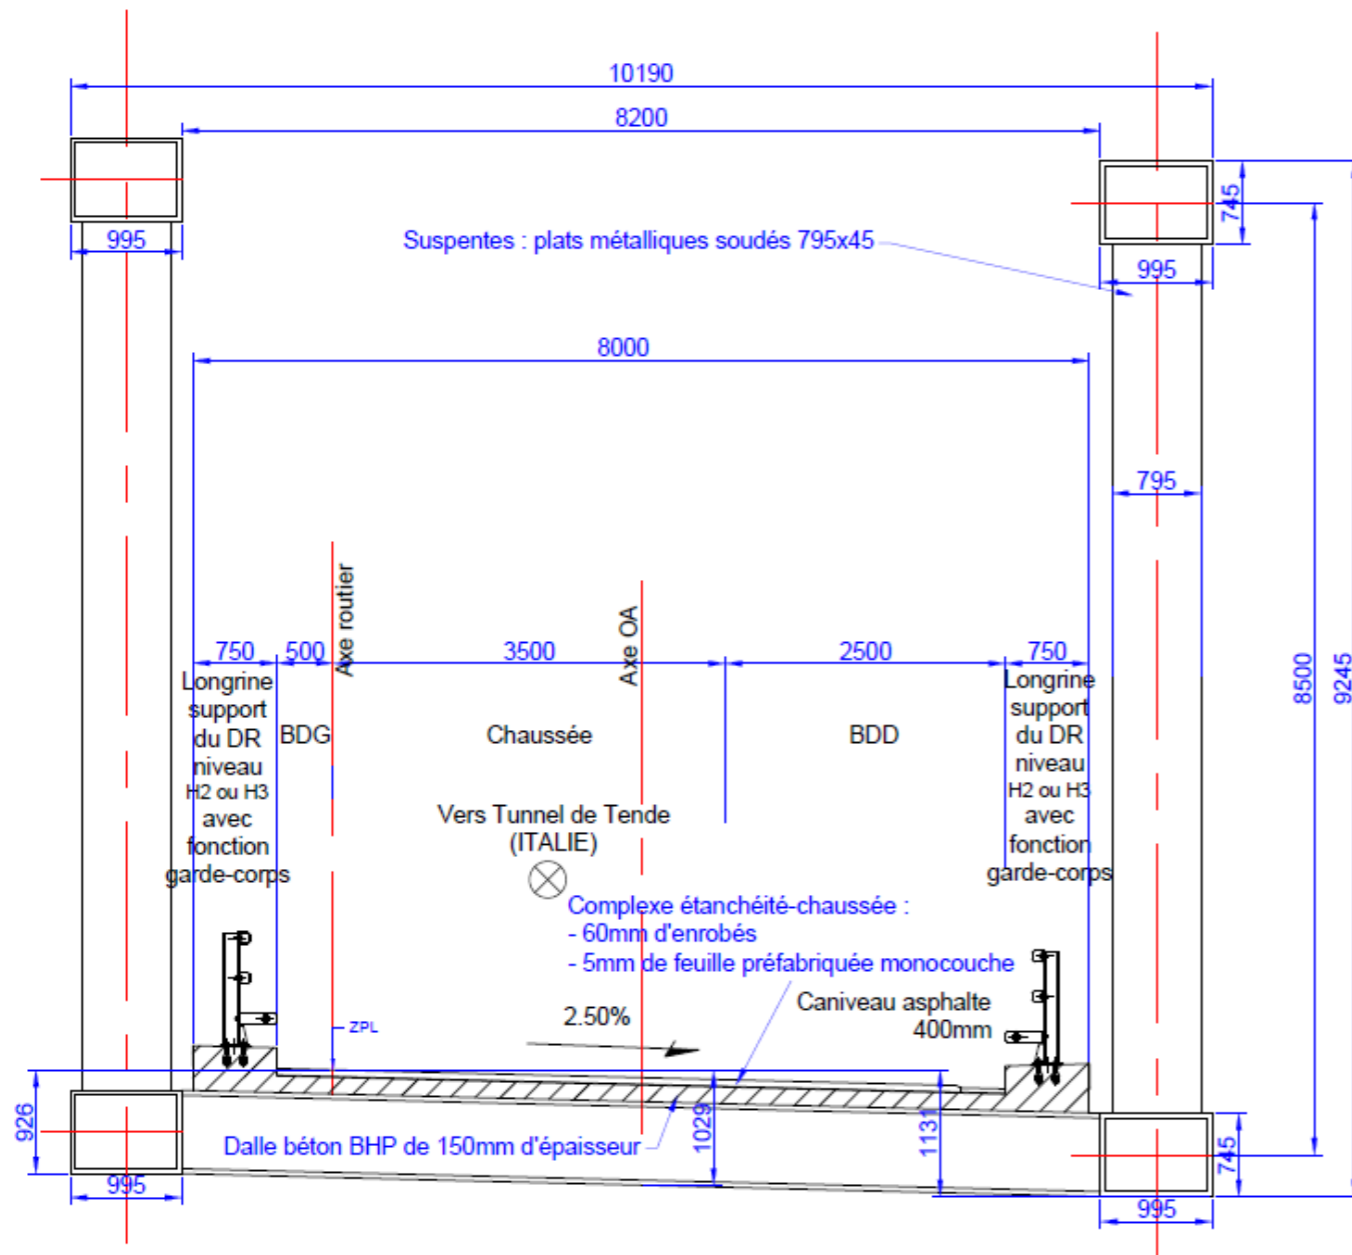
Scenariò 2: Taglio trasversale della struttura Sud
